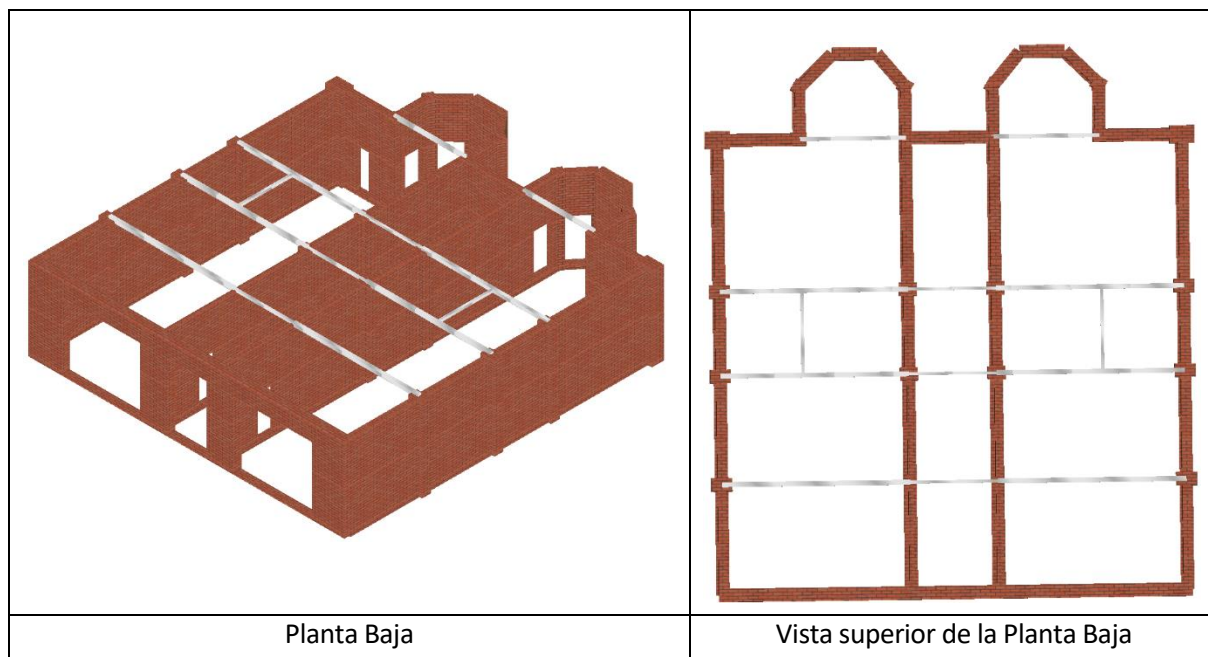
Modelo de Planta Baja (Fuente: Propia)
